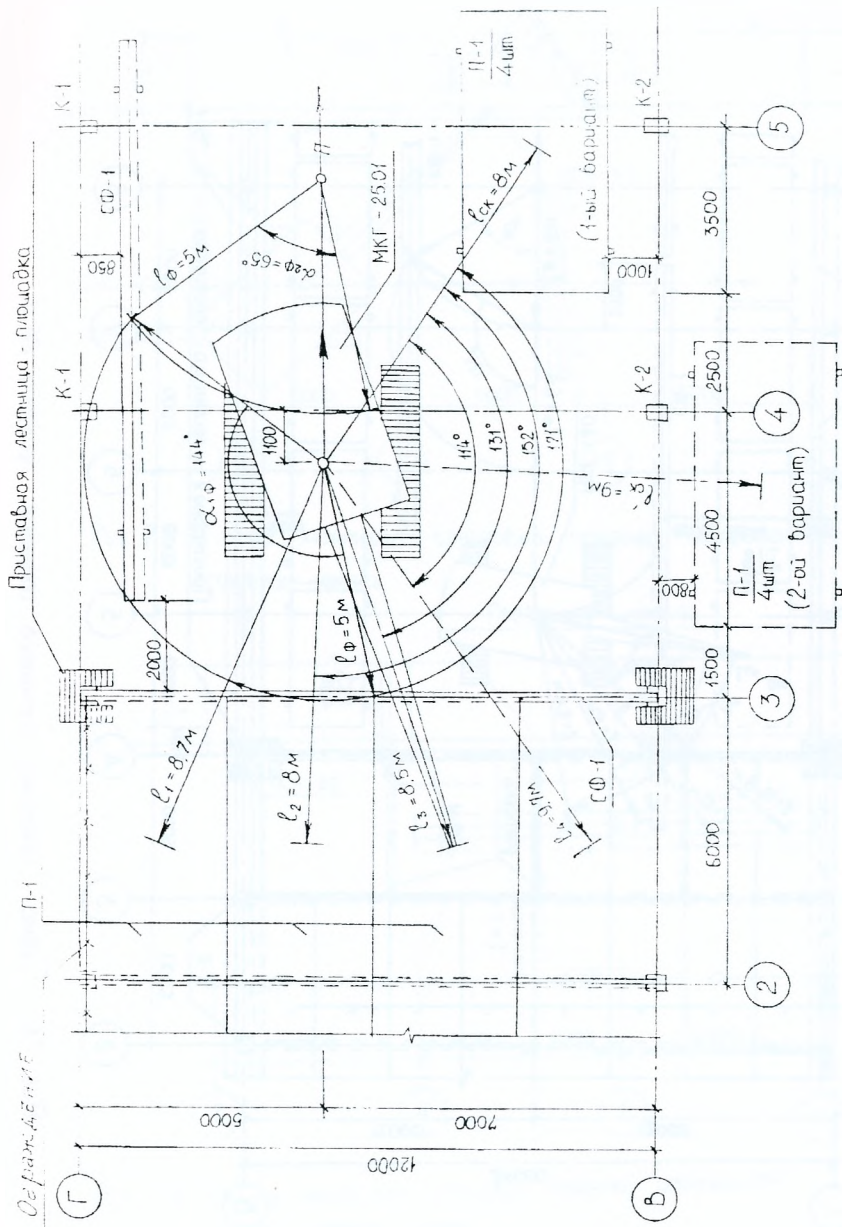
Схема монтажа элементов покрытия пролетом 12 м
